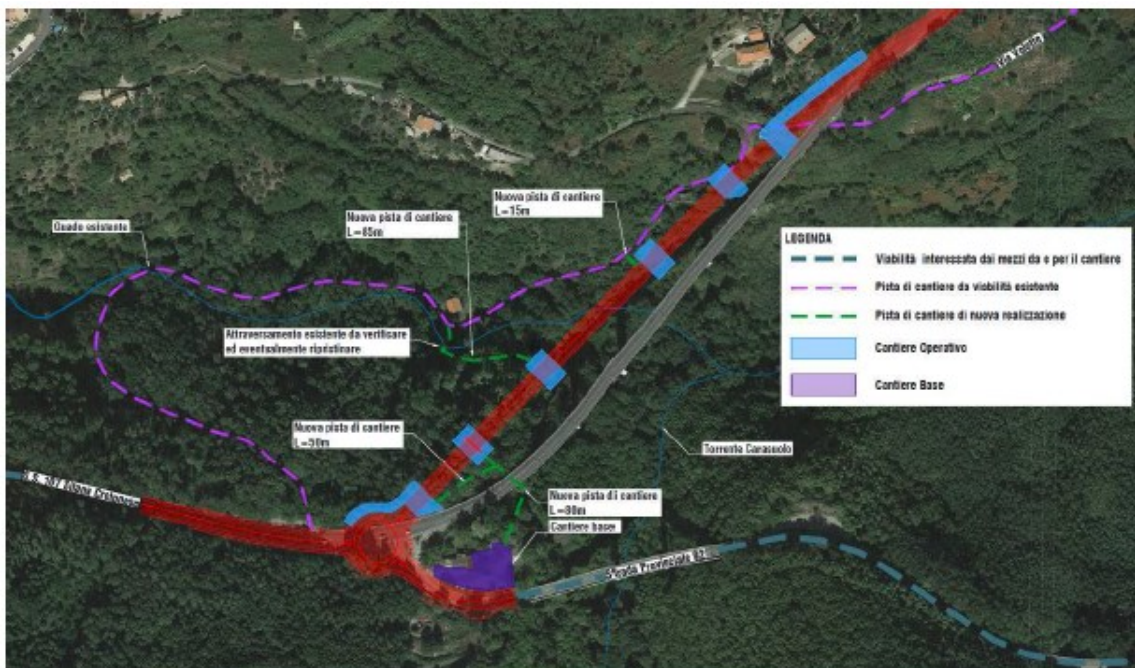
Planimetria aree di cantiere e piste di accesso Viadotto Emoli 1 (Fonte: Lista di Controllo).
